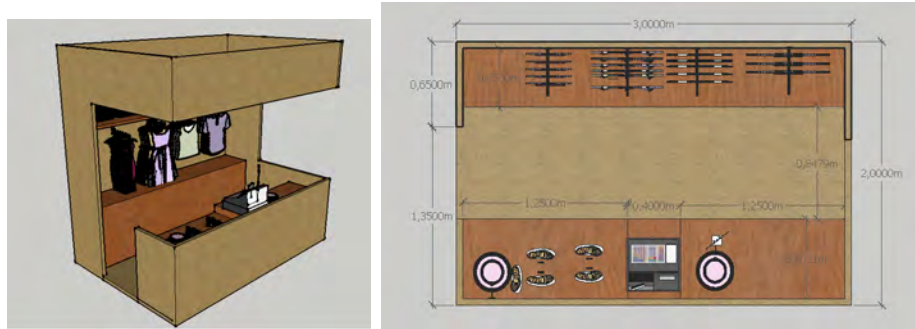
Puestos de artesanías y toquilleras. Elaboración: El Autor.
